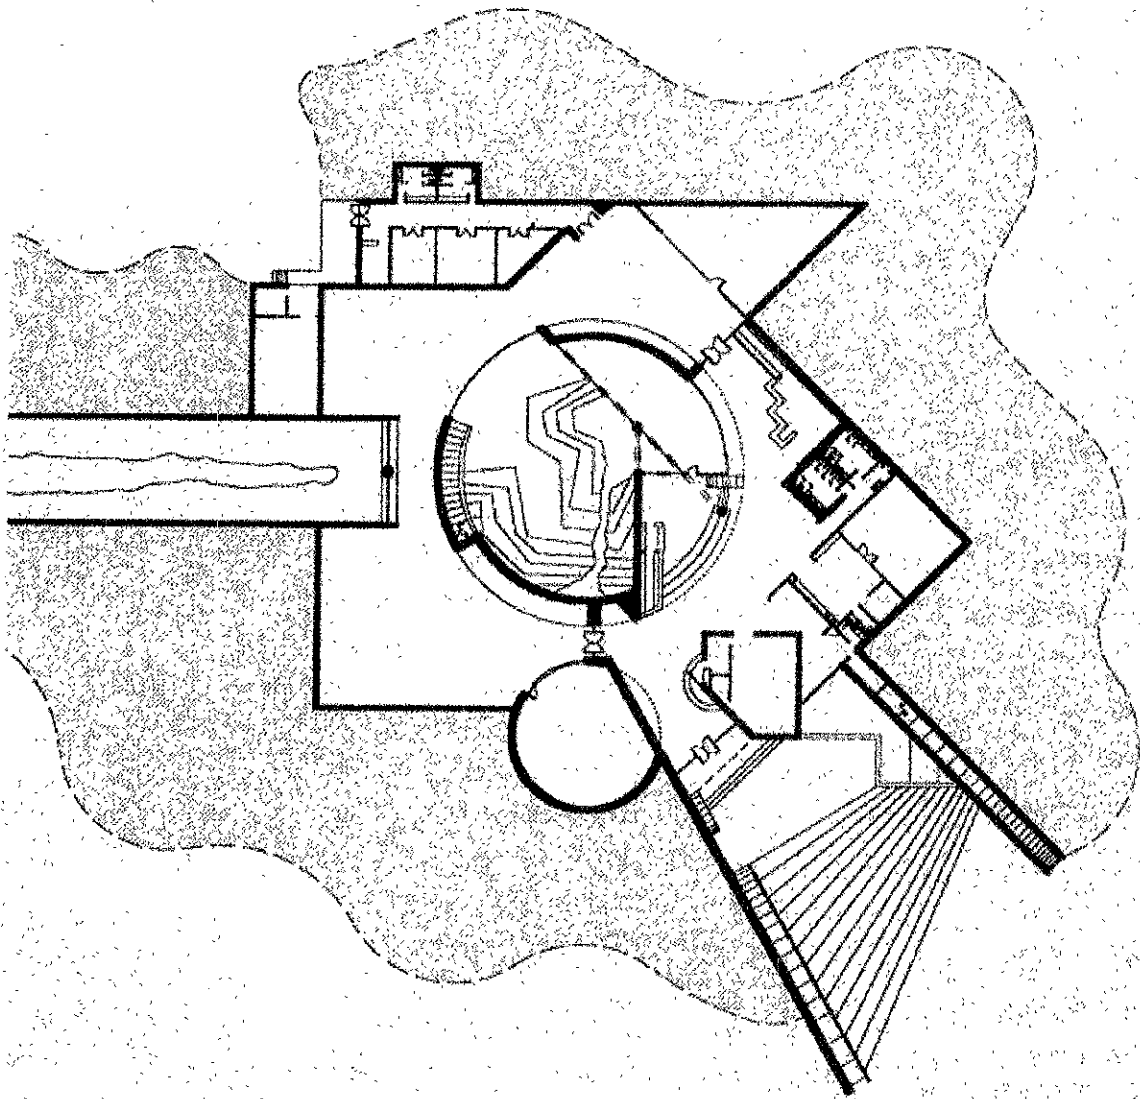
Planta Arquitectónica del Museo de las Culturas del Norte, Paquimé Chihuahua.
